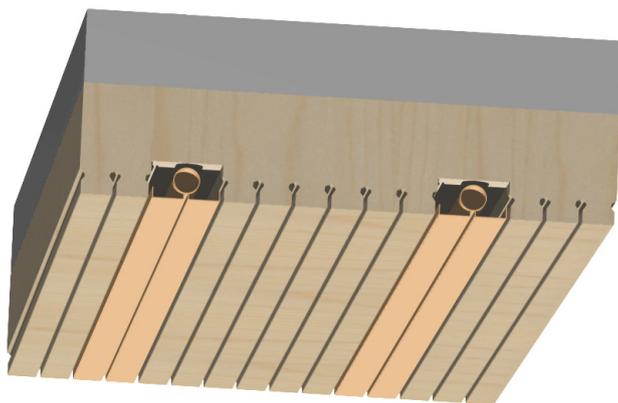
Holzbetonverbunddecke Variante 1:
